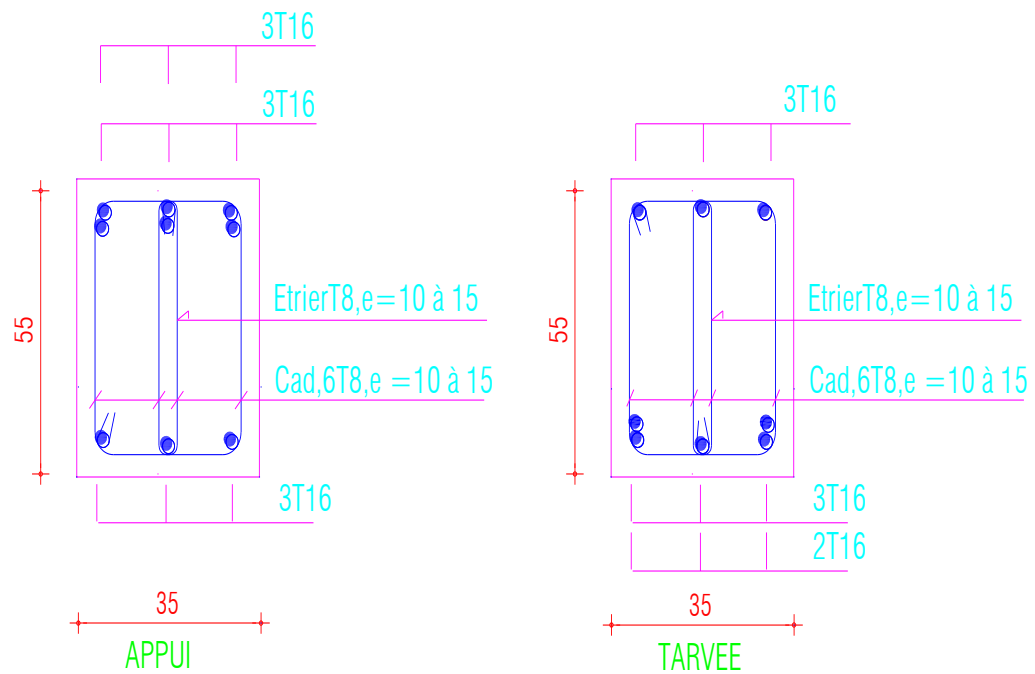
Ferrailage des poutres secondaire (35x55)
